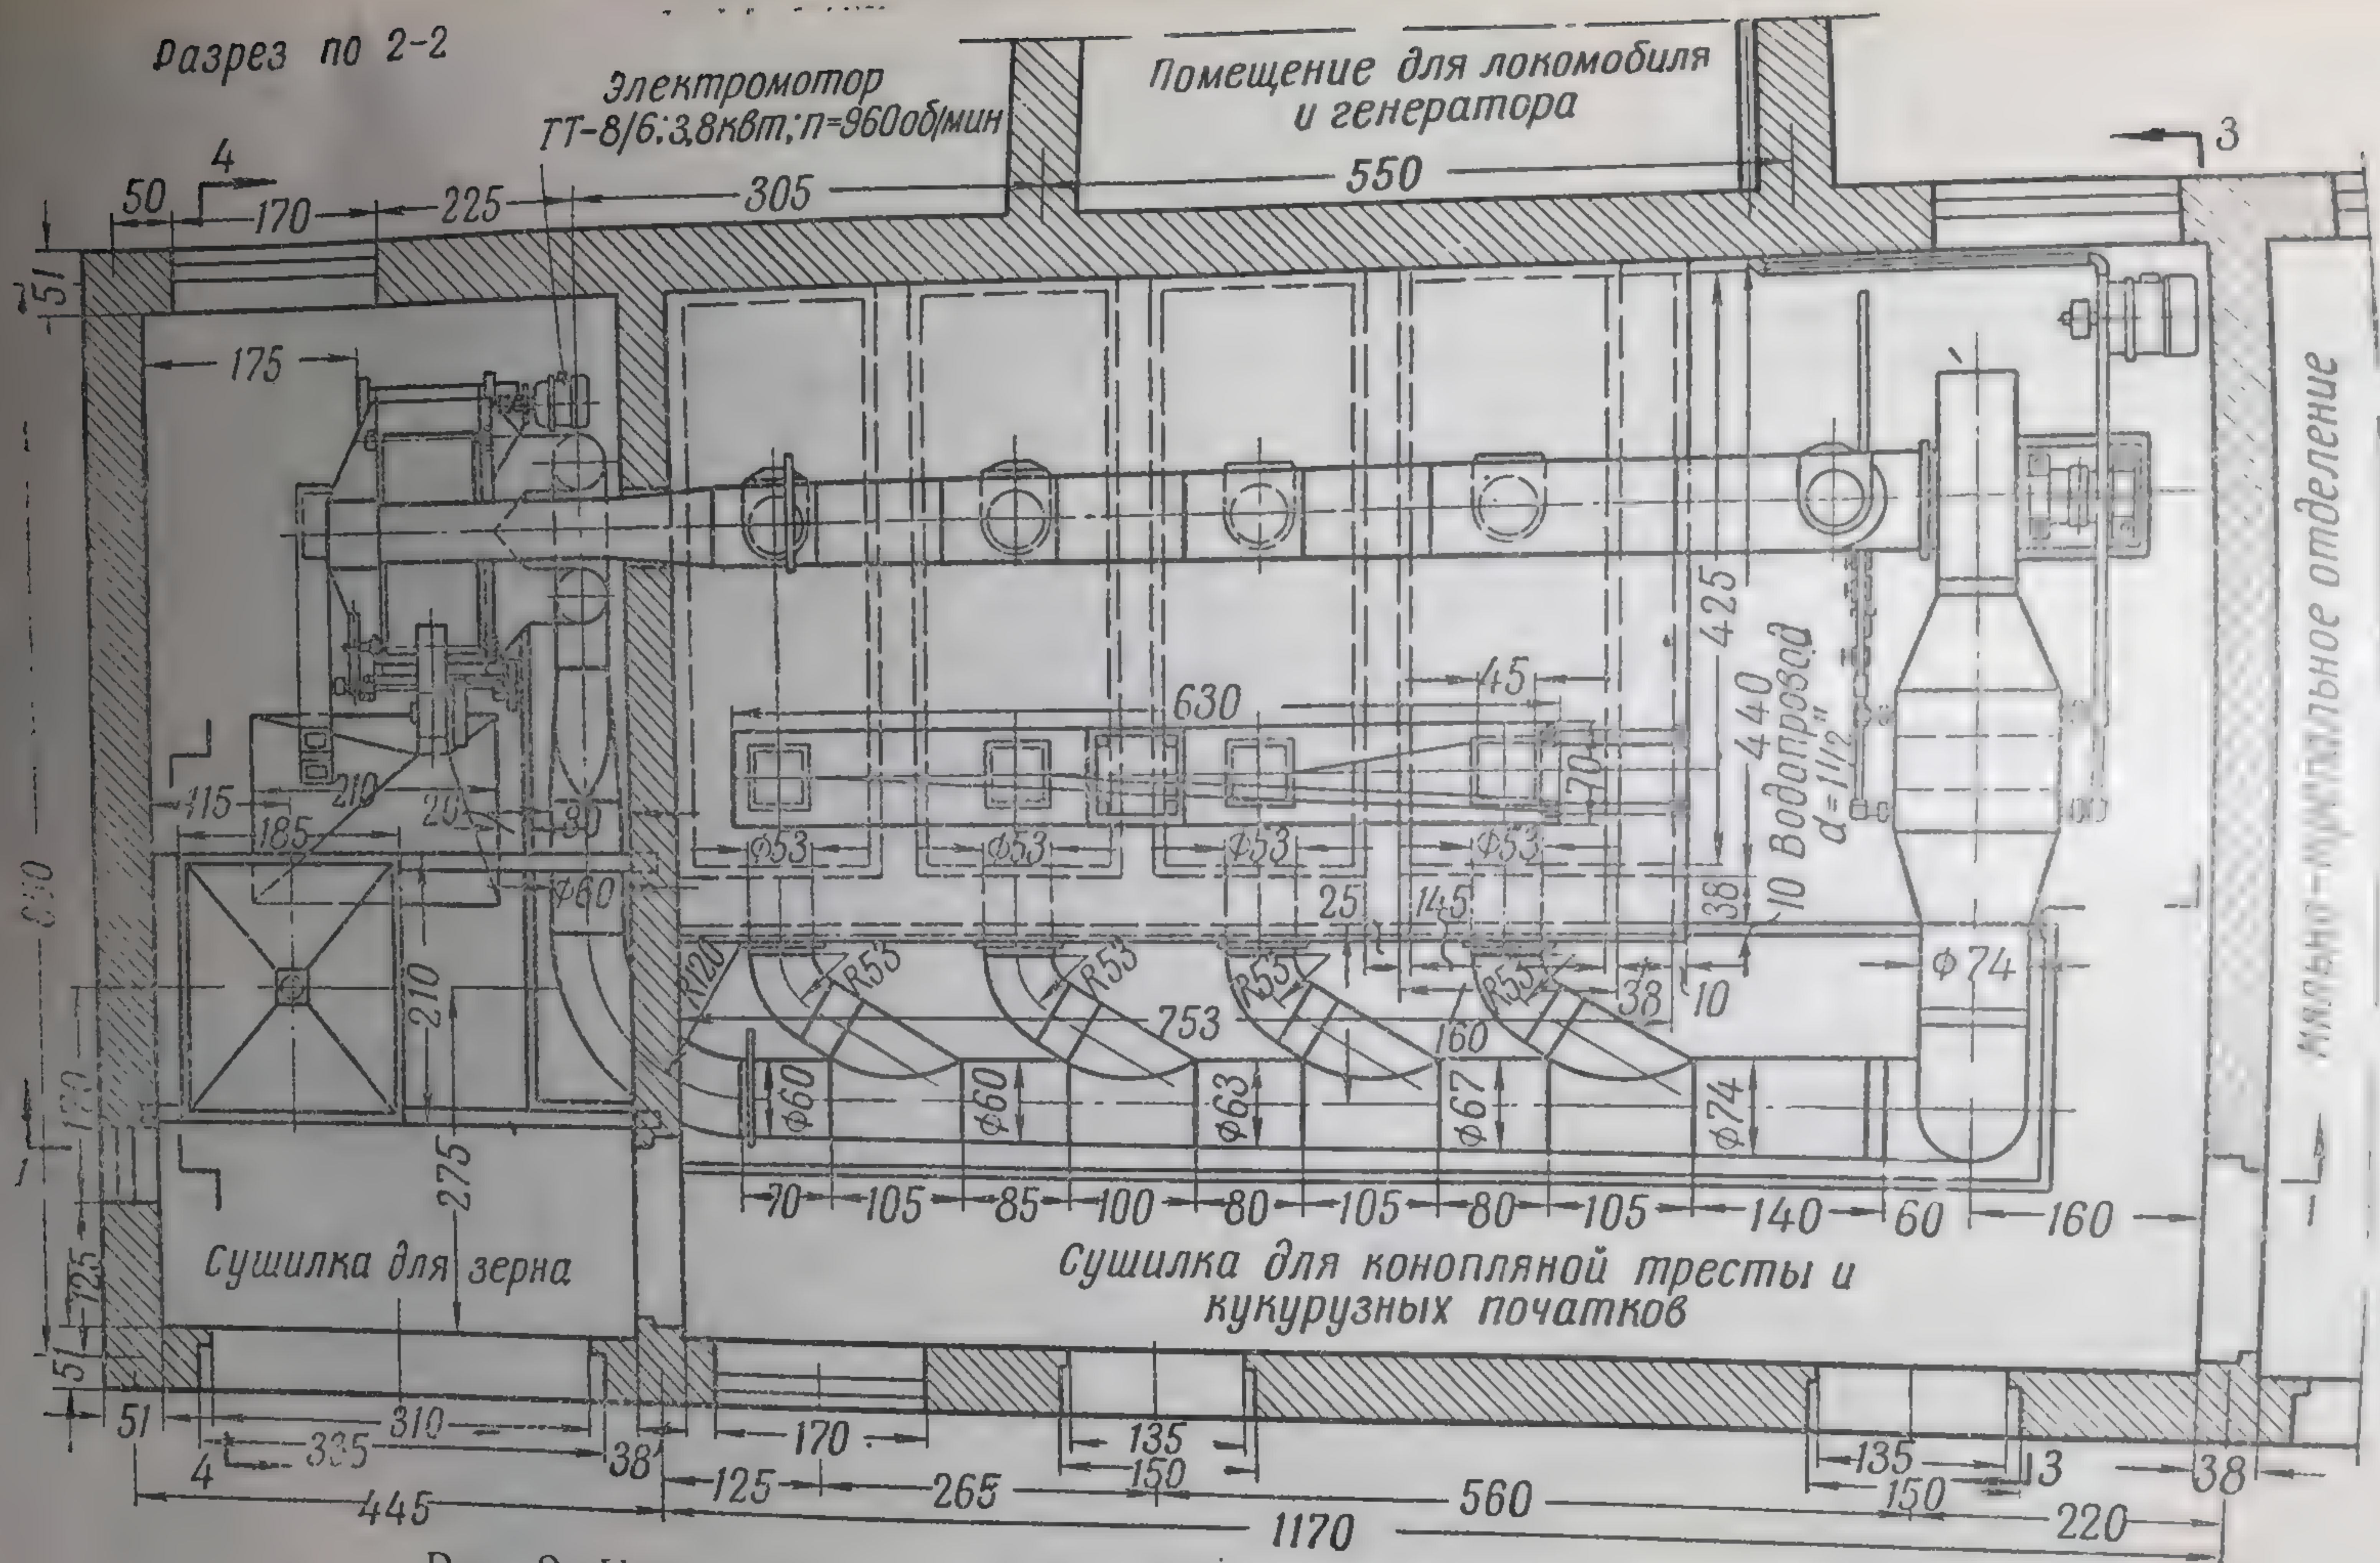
Паровая сушилка для конопляной тресты и зерна.
